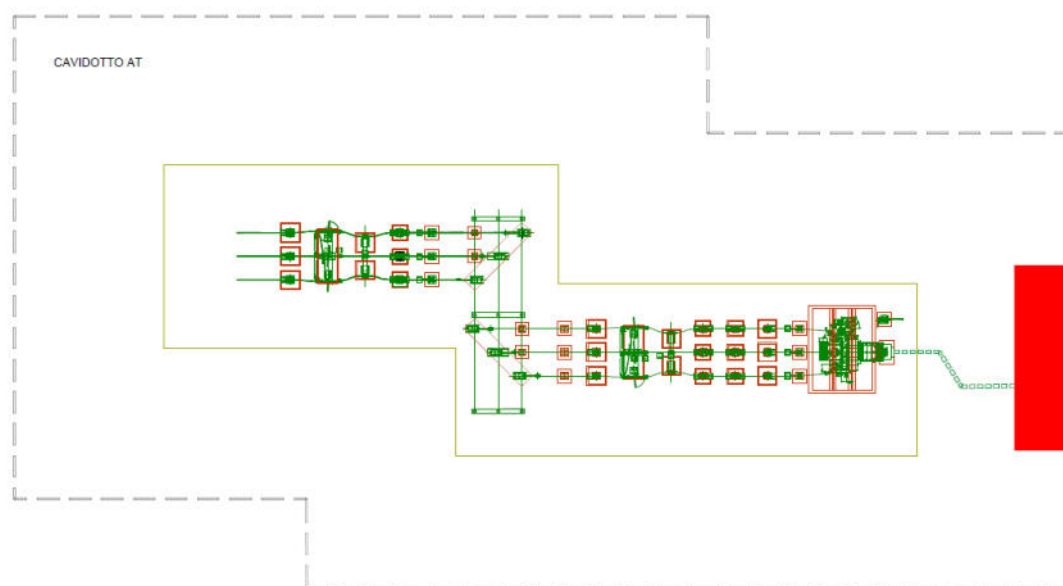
Planimetria SSE AT interna al sito dell'impianto
